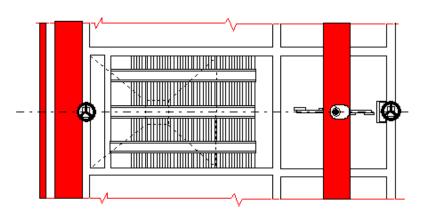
Vista de la parte superior de los módulos de tubos en un decantador de planta rectangular construido en hormigón, sin agua.
